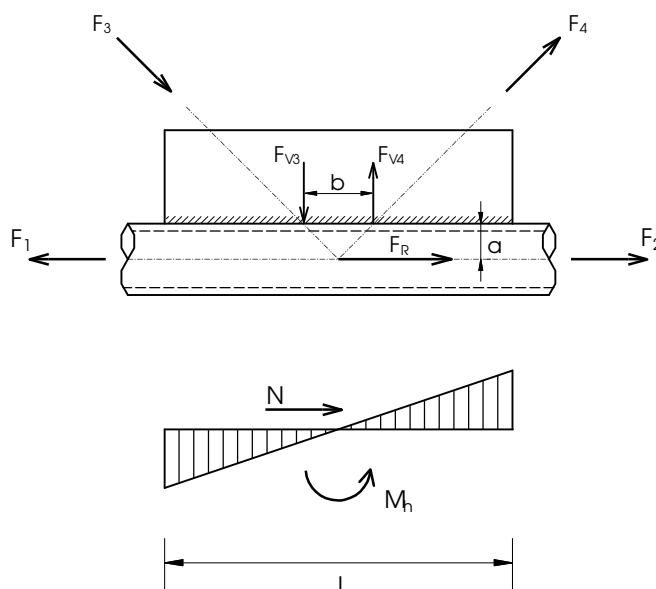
Fixação da chapa de ligação no topo do banzo da treliça.
